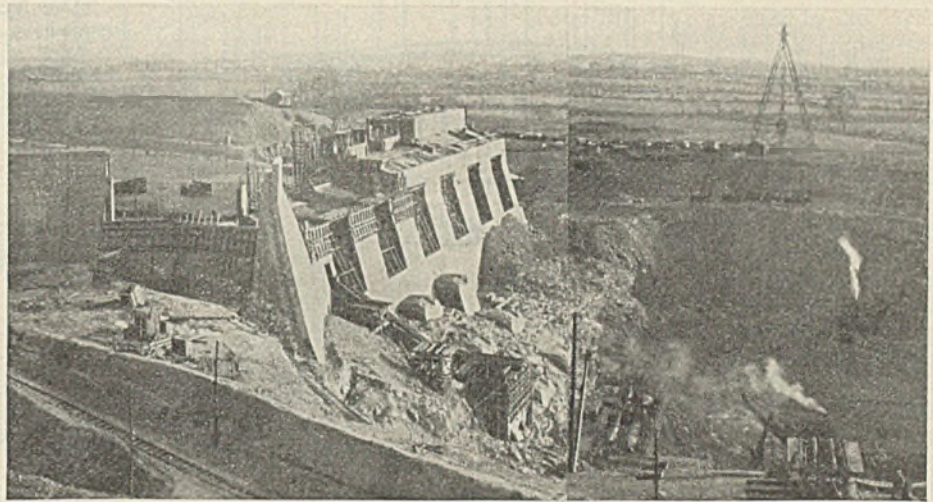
Baustelle von Wasserschloß und Krafthaus.
